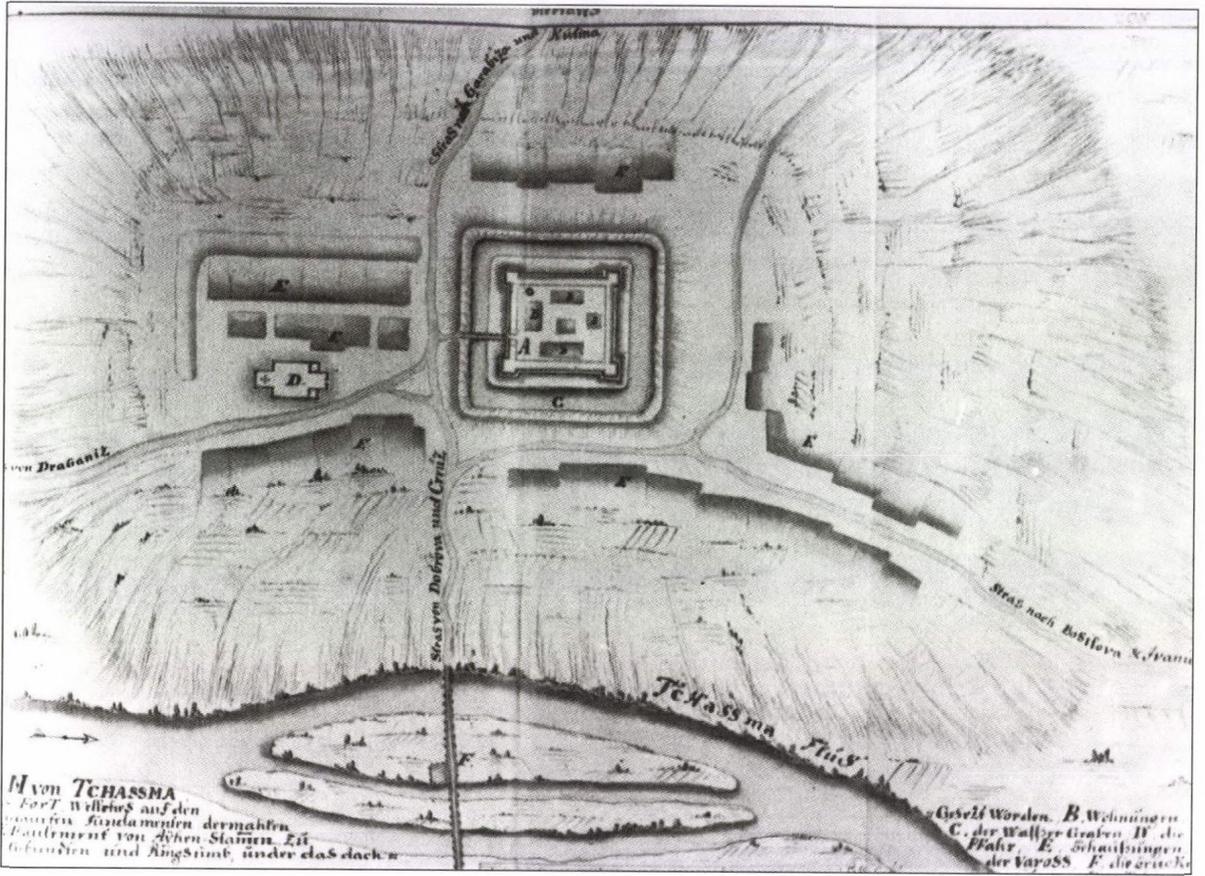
Čazma, Grundriss aus dem 17. Jh.
